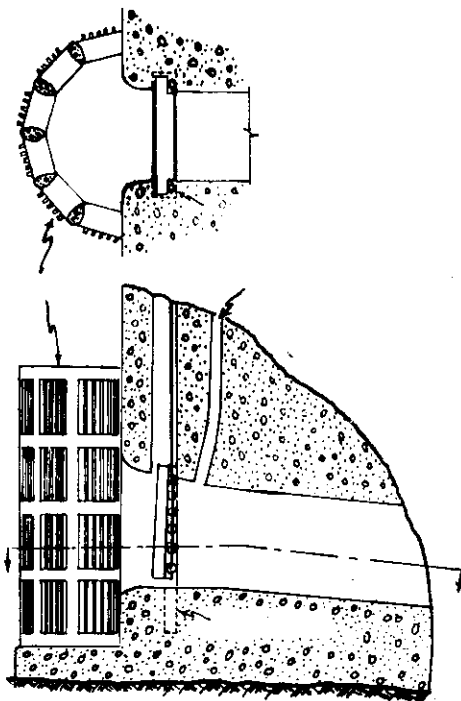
A tomada clássica do tipo torre, vista em corte e em planta
